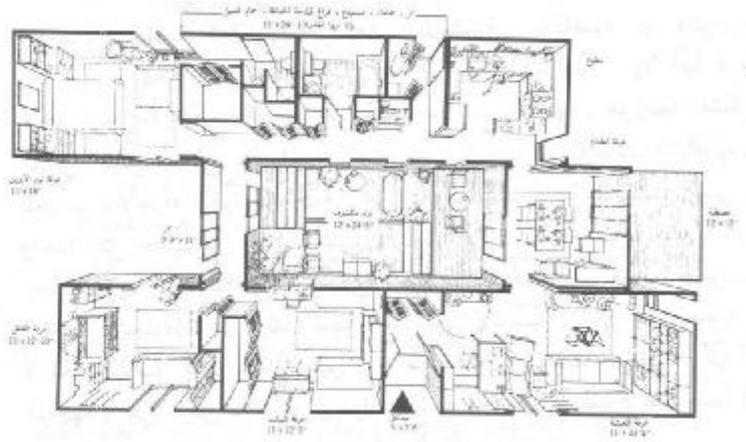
يظهر رسم مسقط أفقي بخط منفرد
